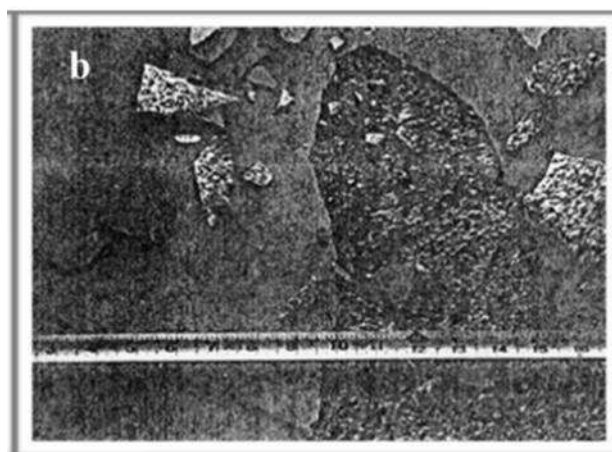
Delaminação do Pavimento (Fonte: Camargo 2010)
